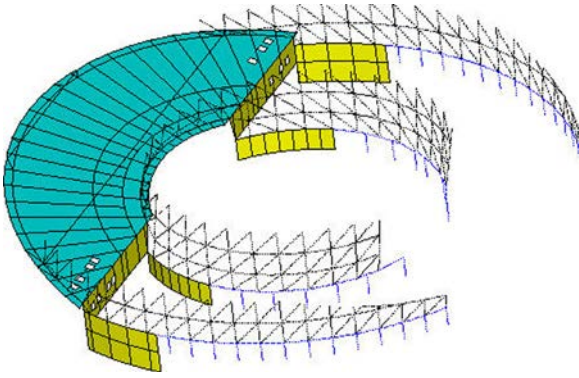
Modelización de las estructuras situadas bajo rasante. Obsérvense las pantallas de apoyo de las celosías y la viga pared en amarillo, así como los soportes y viga riostra en azul.
